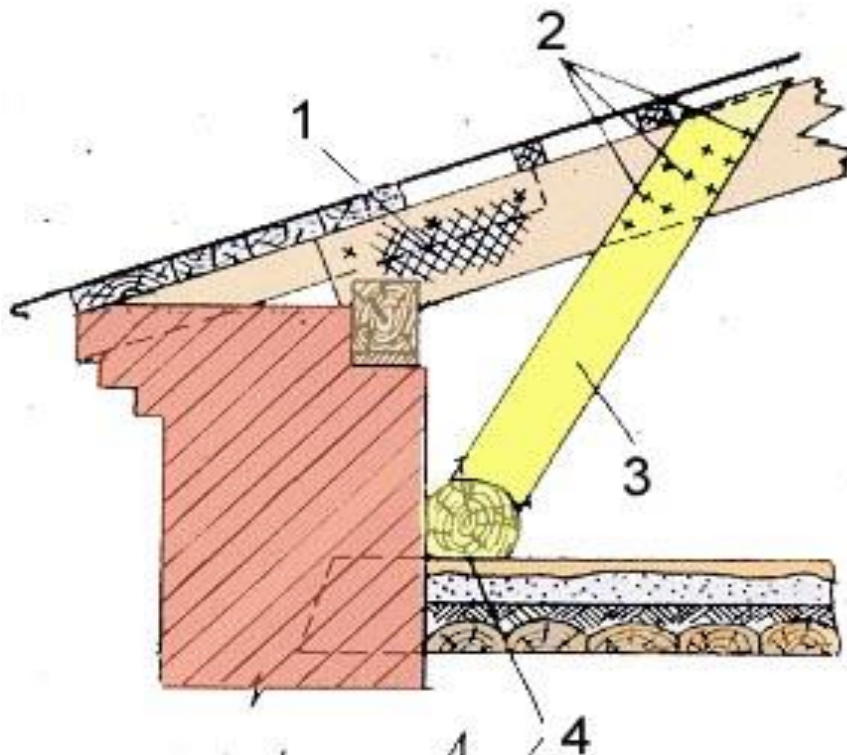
Усиление опорного узла деревянных стропил: 1 – биологическое поражение; 2 – крепежные элементы (гвозди 5x150); 3 – подкос; 4 – распределительная балка.
